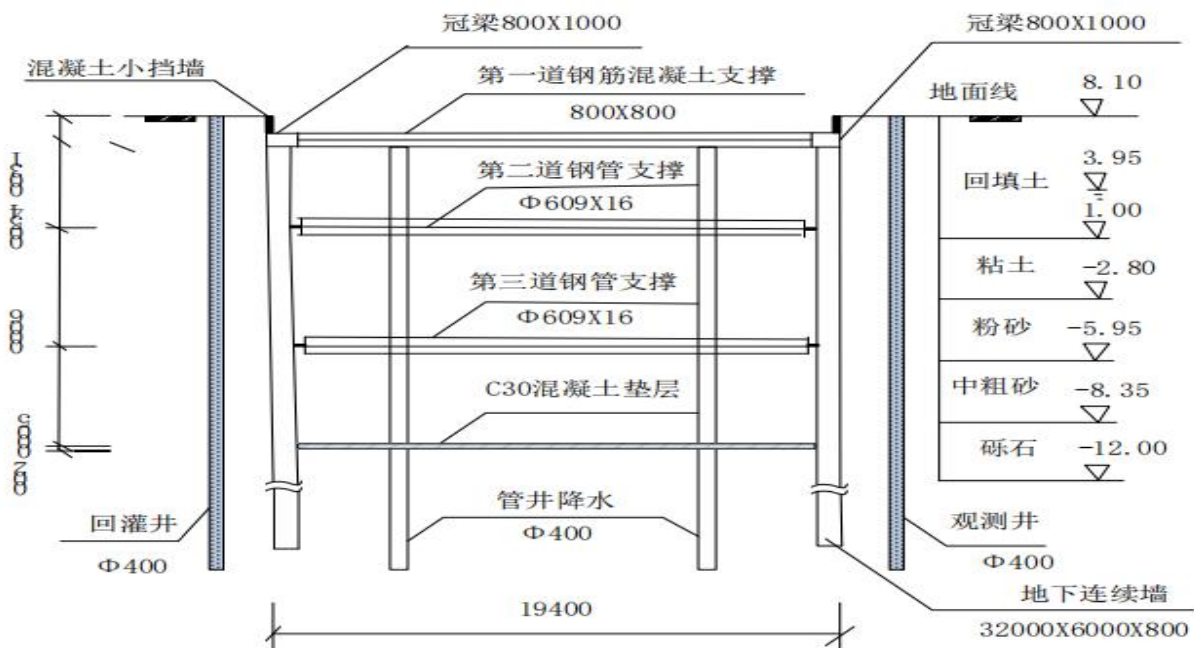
地铁车站明挖施工示意图（高程单位：m；尺寸单位：mm）
